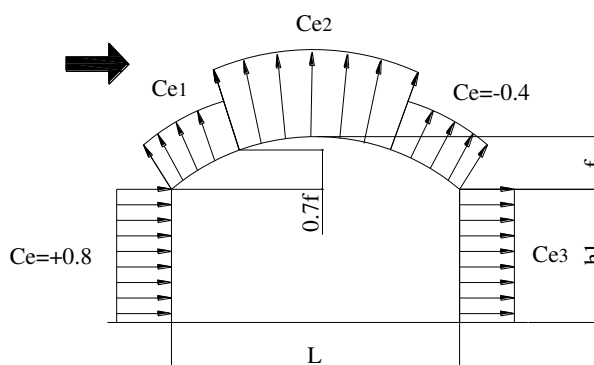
Расчетная схема для определения ветровой нагрузки.
